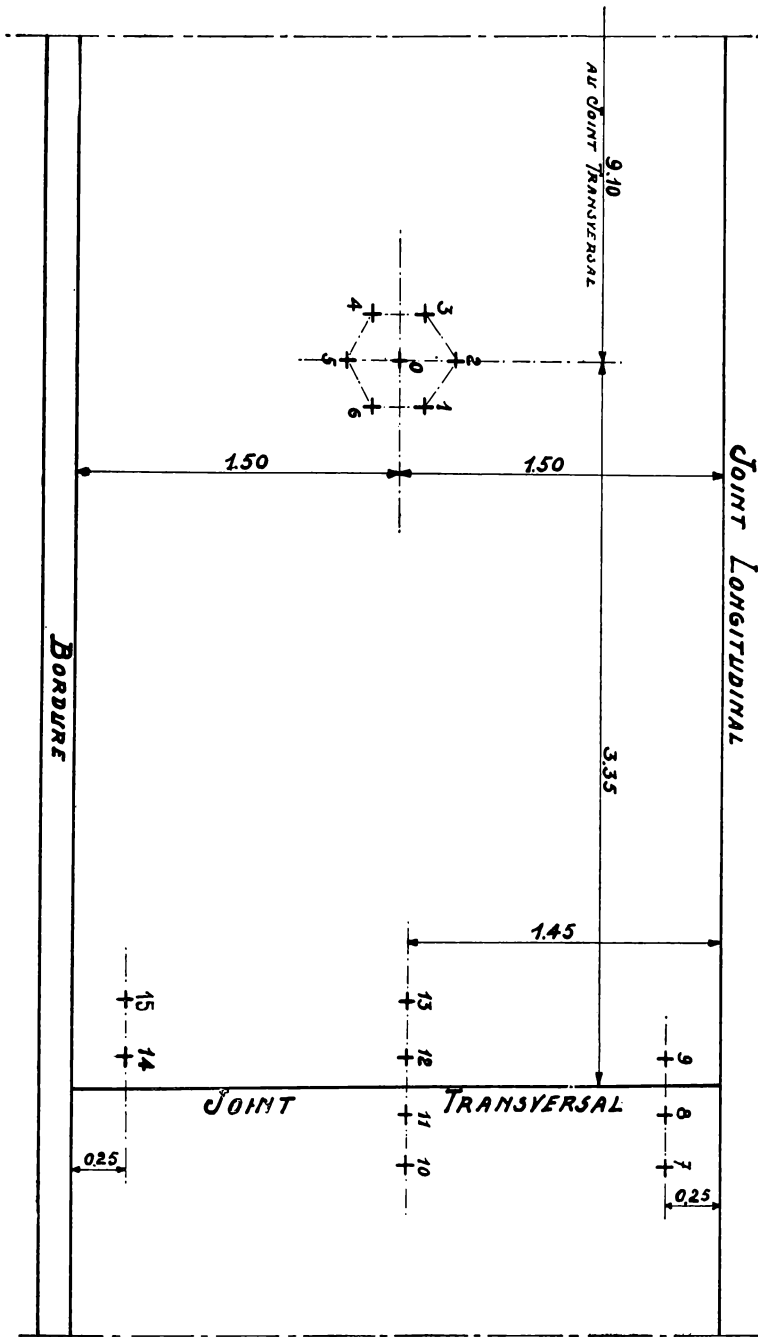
Disposition de bases de mesure sur une dalle en béton et à cheval sur un joint.
